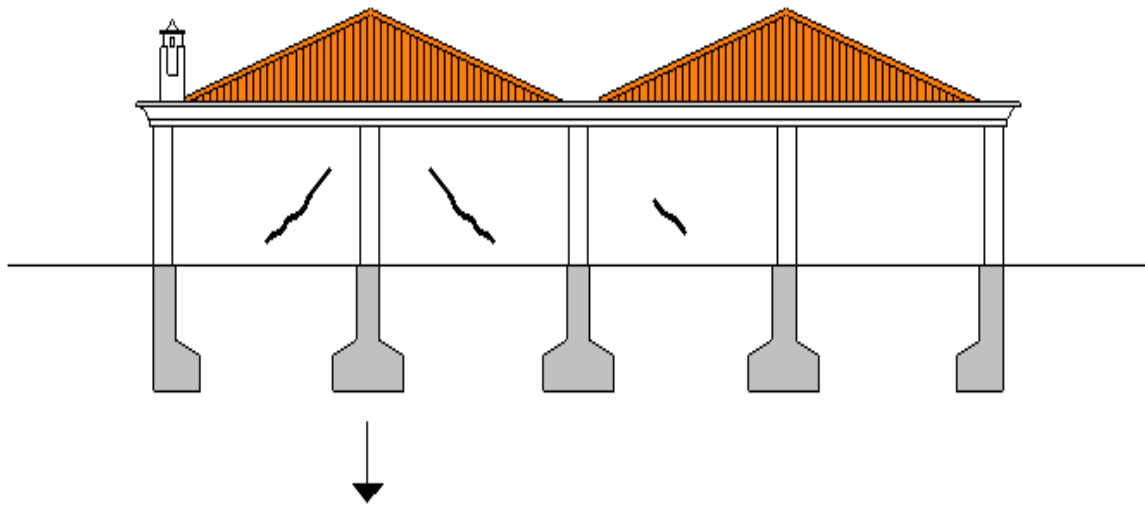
Família de fissuras originadas pelo assentamento de parte da estrutura (Modificado, Ortiz, 1983).
